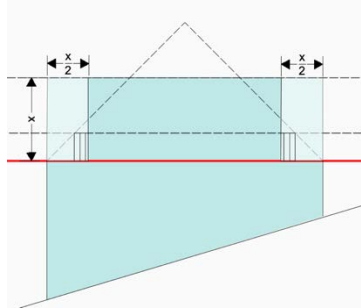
Reguläres Attikageschoss mit Dachaufbauten (neuPBG)
